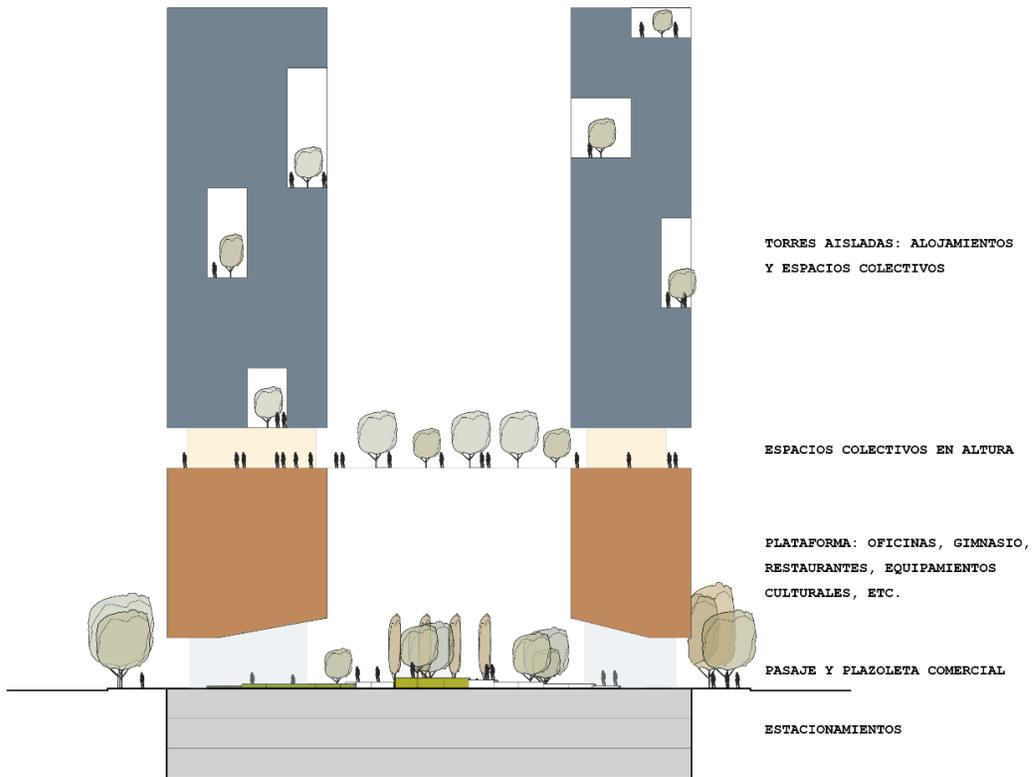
Sección transversal: volumetría propuesta. (Elaboración propia, 2020)
